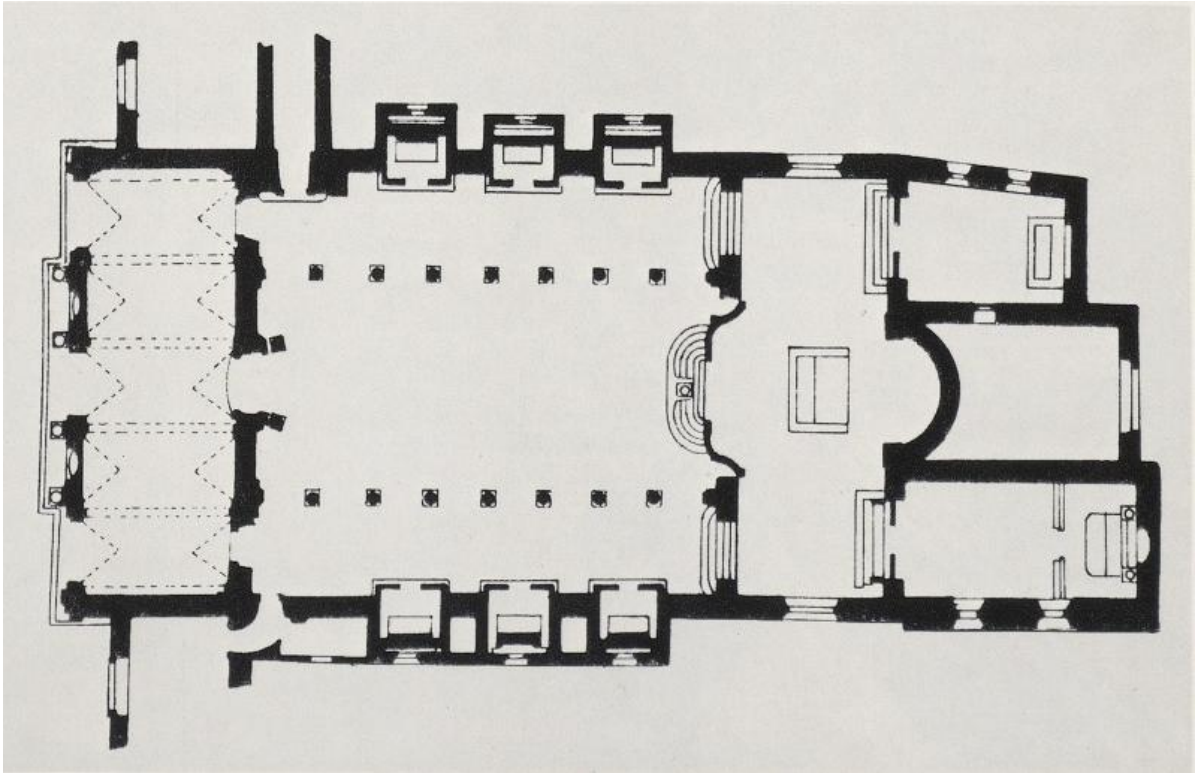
Grundriss der Kirche San Bartolomeo all'Isola, erste Hälfte des 12. Jh, Rom.
